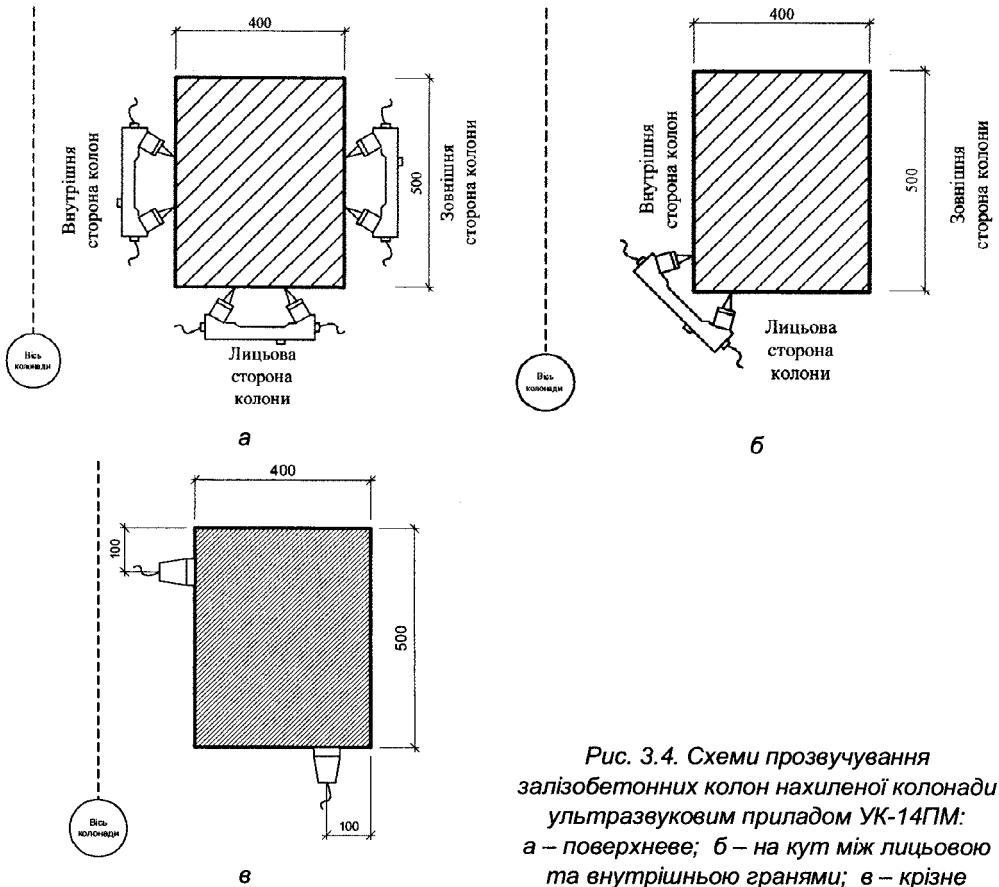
Схеми прозвучування залізобетонних колон нахиленої колониади ультразвуковим приладом УК-14ПМ: а – поверхневе; б – на кут між лицьовою та внутрішньою гранями; в – крізне
